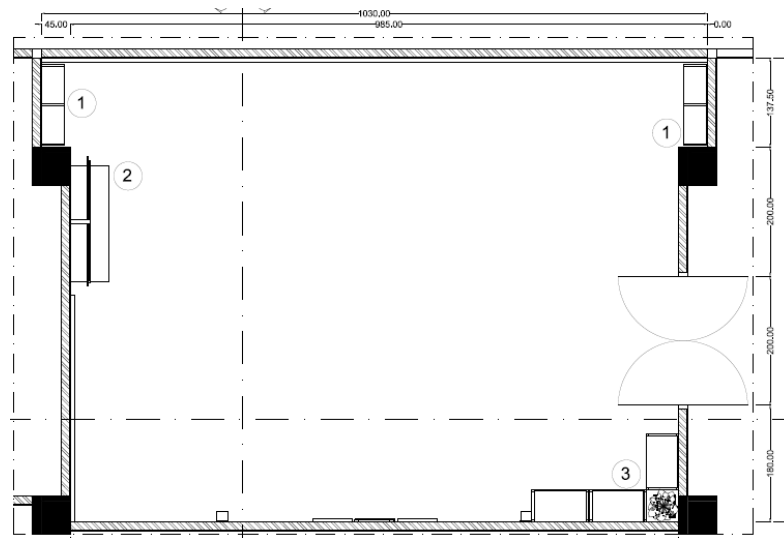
Layout Furnitur Ruang Tepilih 2
